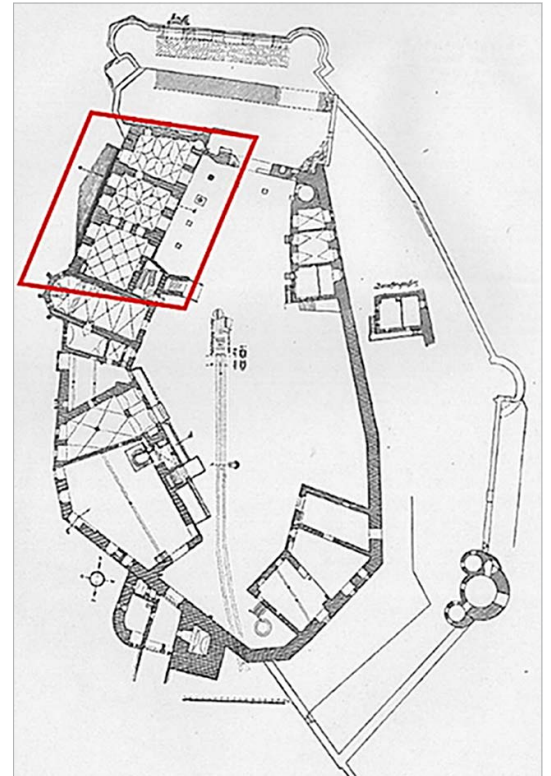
Grundriss Erdgeschoss Hauptbau Schloss Neuburg am Inn, Markierung: Raumfolge der drei Prunkräume. Grundriss: Groeschl 1924, S. 36; Markierung: Verfasserin.
